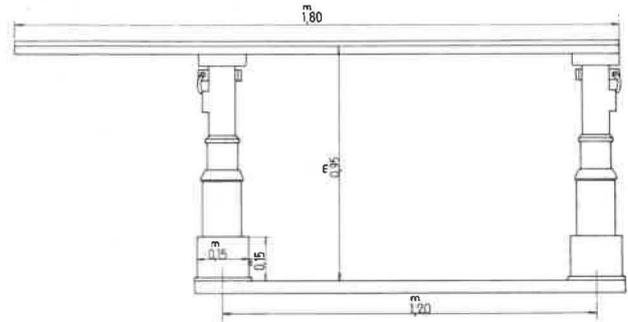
Portique constitué de 2 étaçons hydrauliques Dowty, d'une forte semelle avec pots pour supporter les étaçons et d'une bèle en profil ondulé.
